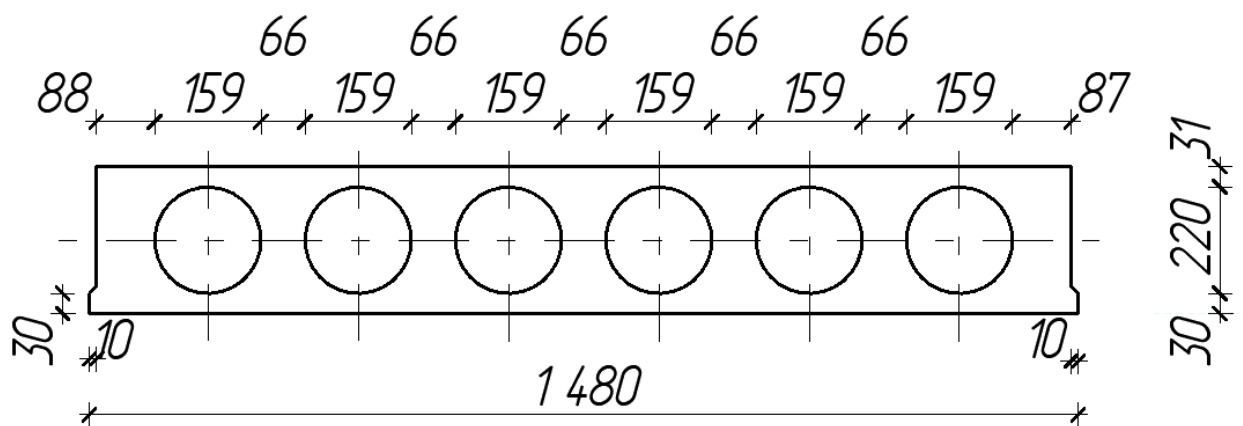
Поперечний переріз багатопустотної плити перекриття
